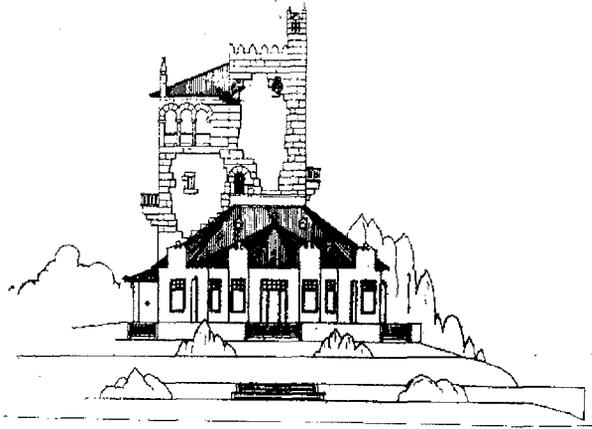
Proyecto de Restaurante del Monte Santa Tegra (A Guarda). Alzado fachada principal. Antonio Palacios. (Revista Nacional de Arquitectura)
